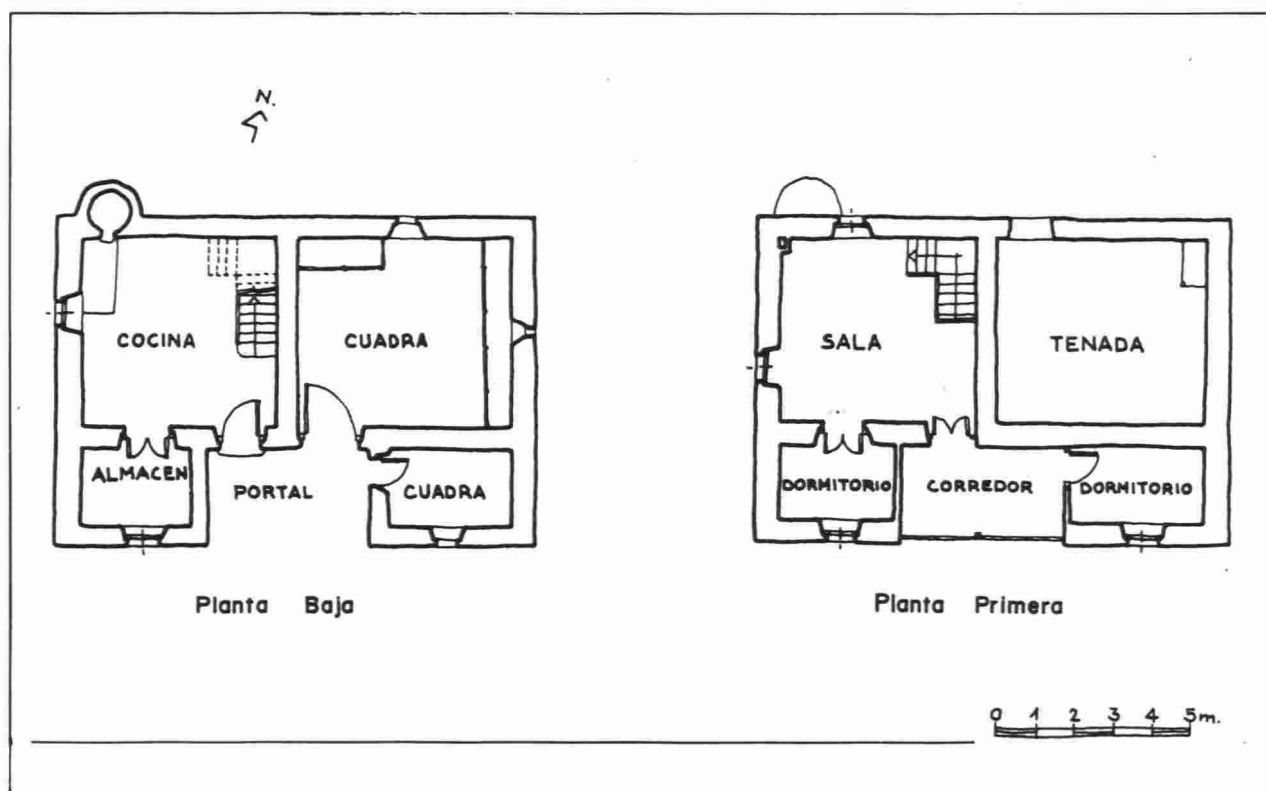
Planta tipo de casa con corredor entre dos cuerpos.
